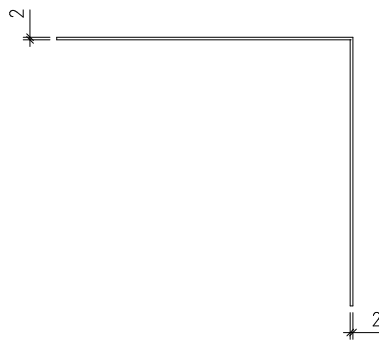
Angle rentrant – Pose verticale (avec fixations cachées en extrémité)
